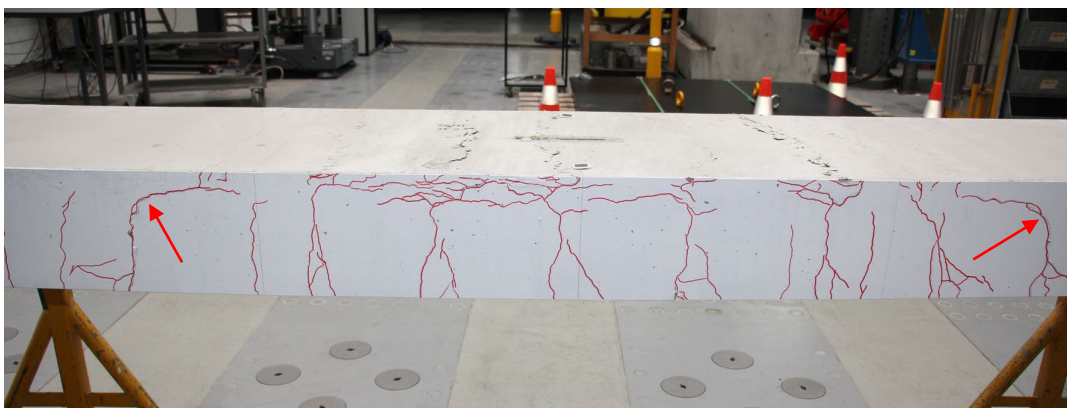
Angezeigte Risse nach dem Versuch. Gut sichtbar sind die Biegeschubrisse, die in die Druckzone laufen (Pfeile) und das Betonstauchen.
